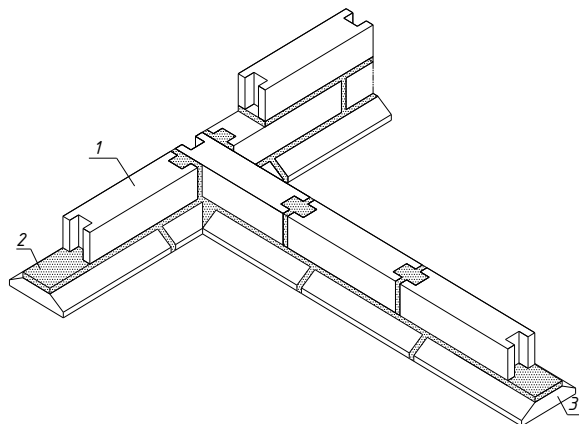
Вариант сборного ленточного фундамента: 1-фундаментный блок, ФБС; 2-цементно-песчаный раствор; 3-фундаментная плита, ФЛ
